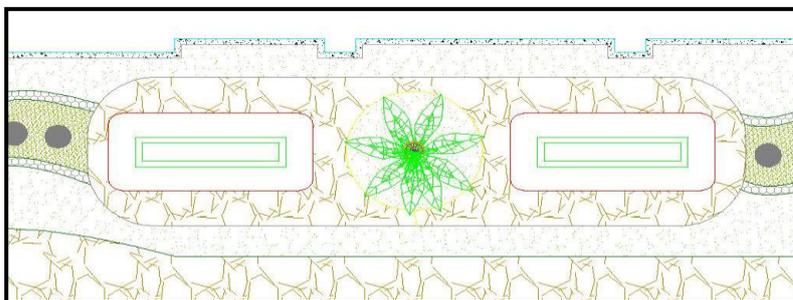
Planta baixa dos bancos ao lado do MIS
